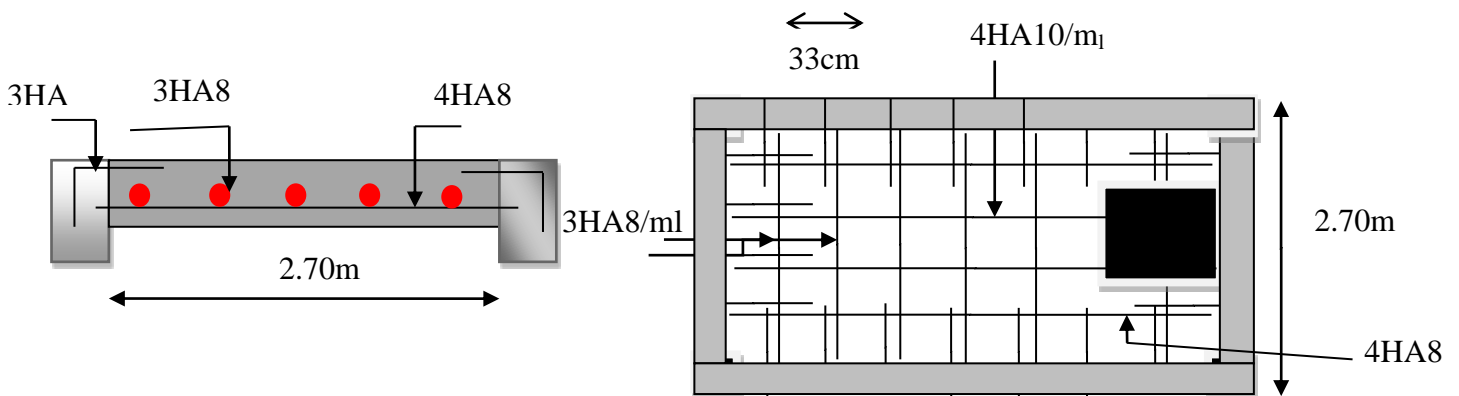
Schéma de ferrailage de la dalle sur 4 appuis
